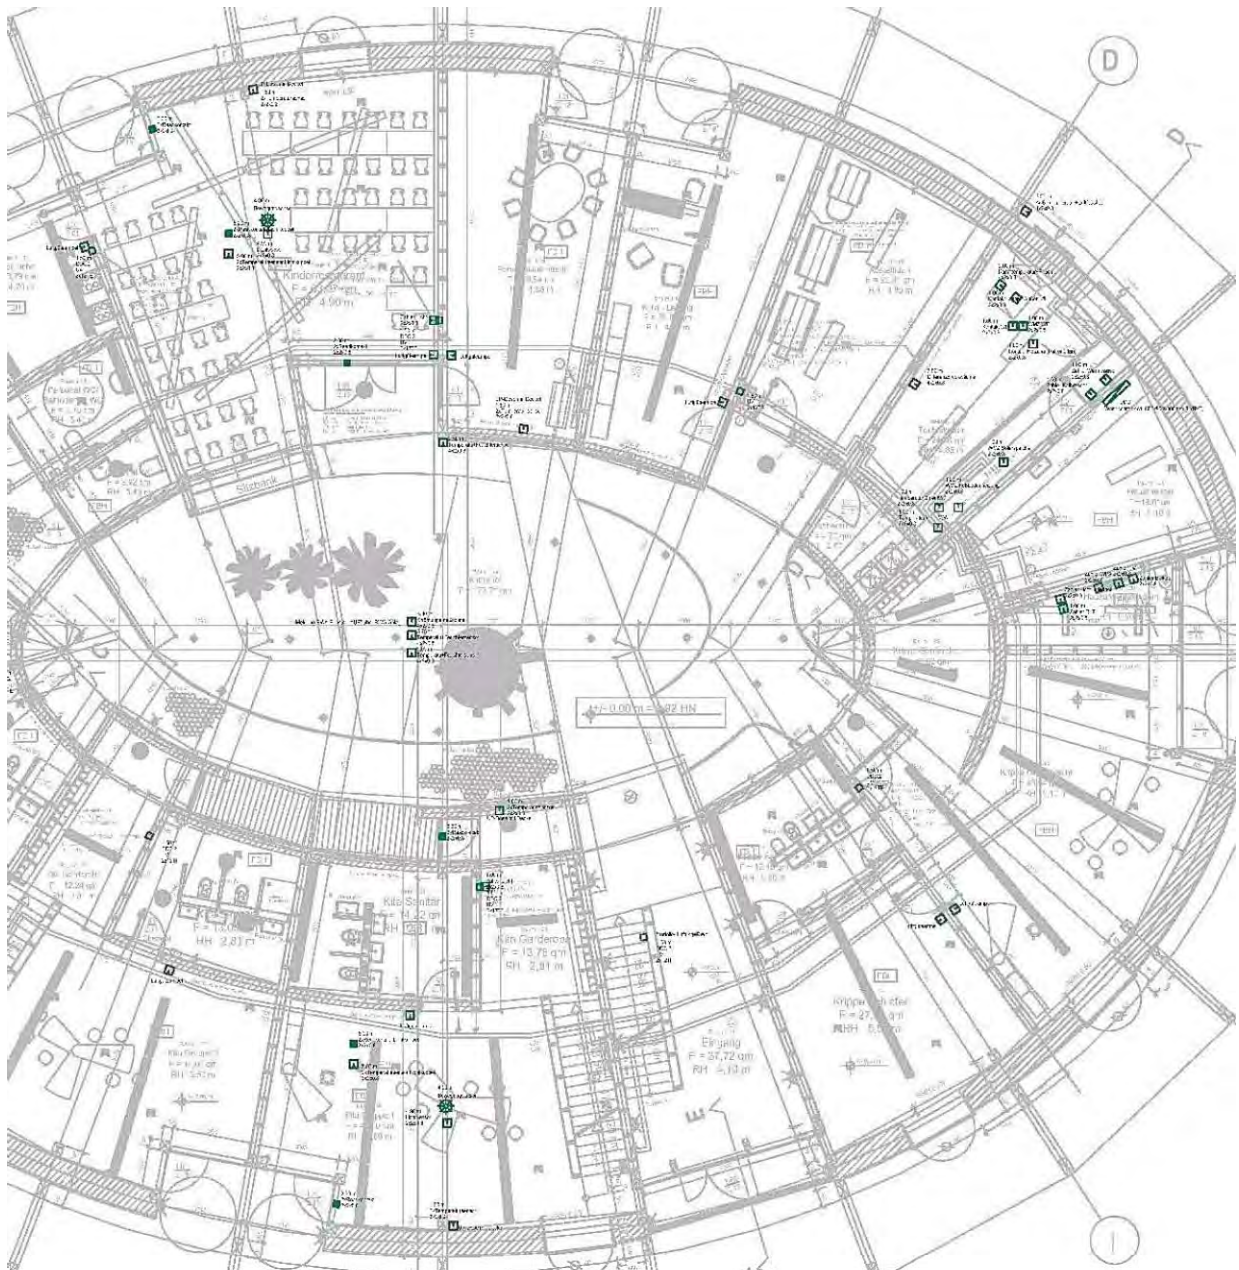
Sensoren im Gebäude – Grundriss EG, Auszug aus der Ausführungsplanung, Elektro- Ingenieurbüro Popp
